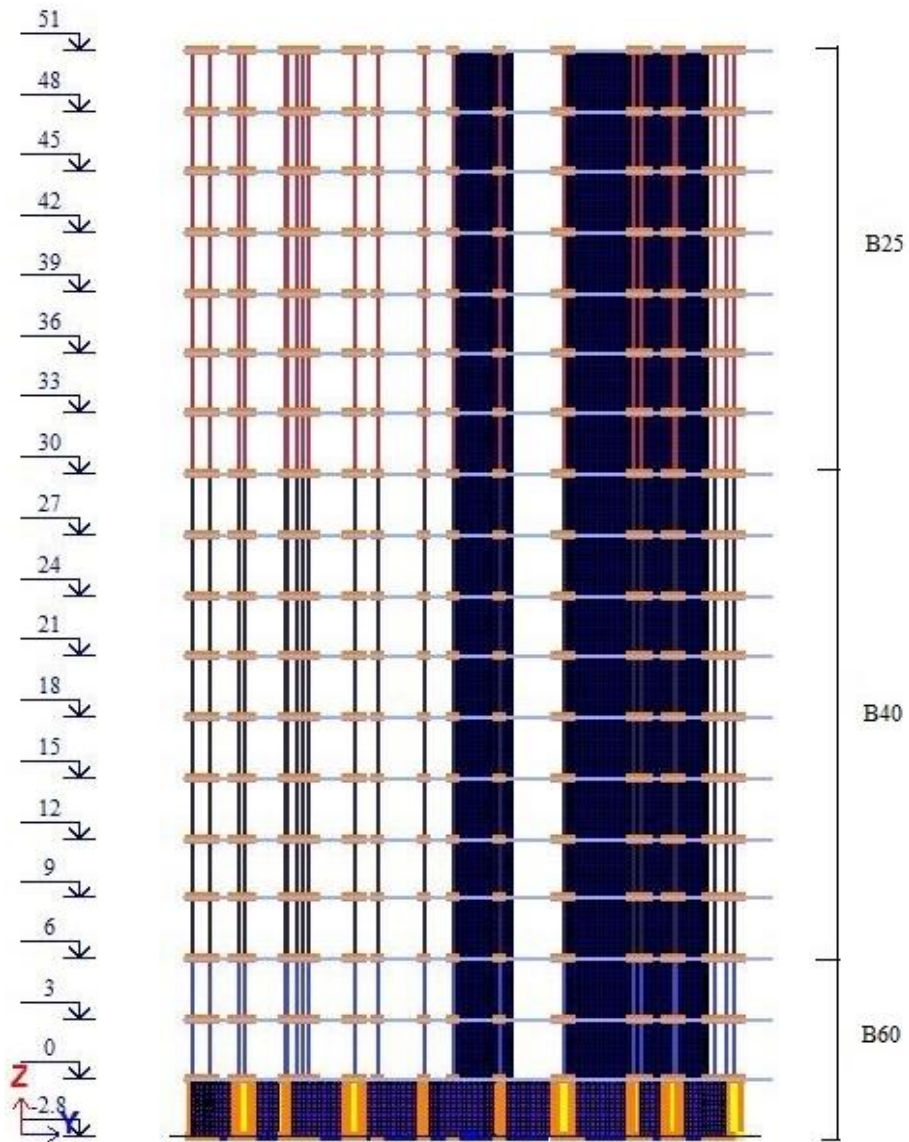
Классы бетона для пилонов 16-этажного здания
